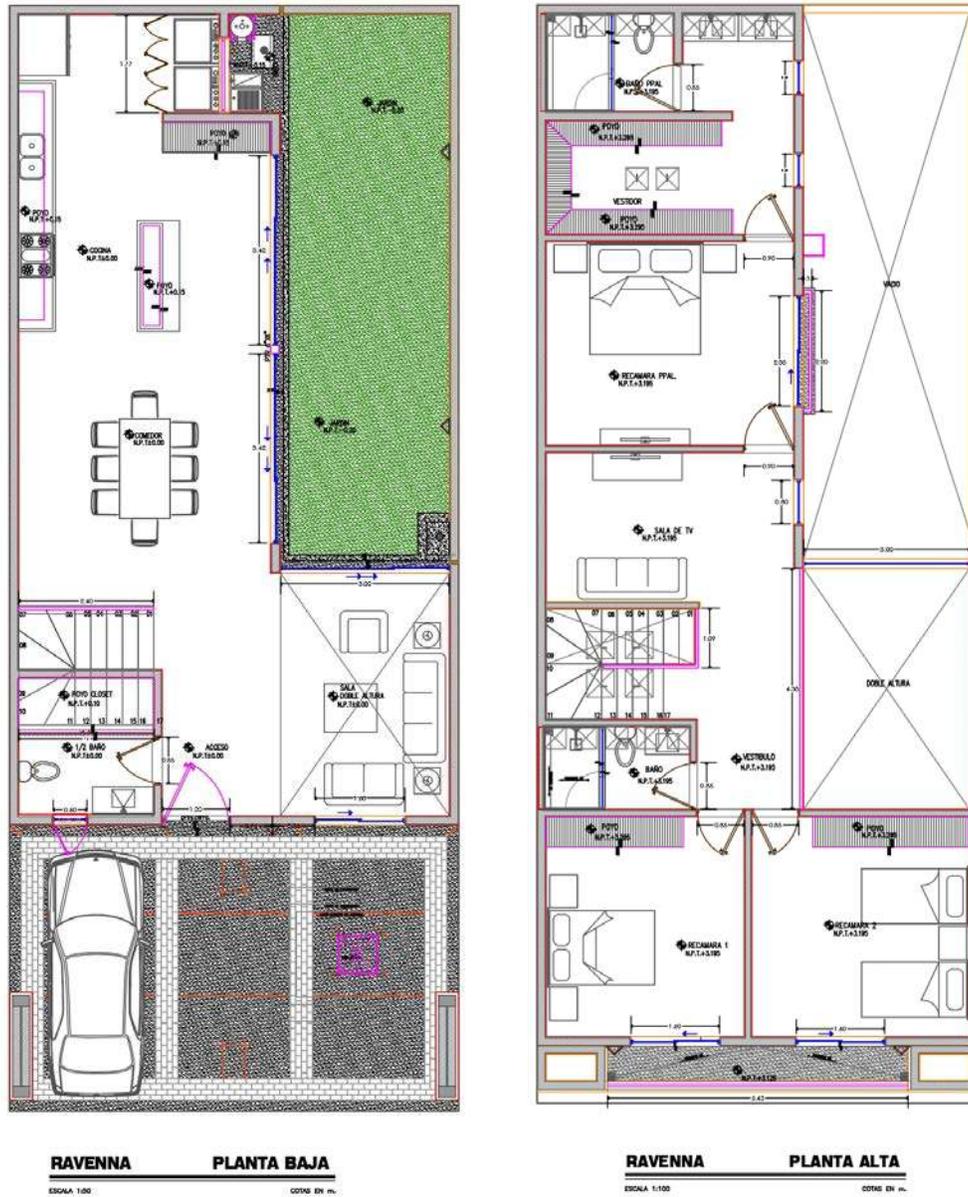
Distribución de planta baja y planta alta en prototipo "Ravenna" (AIVIA Conceptos Inmobiliarios, 2021)
